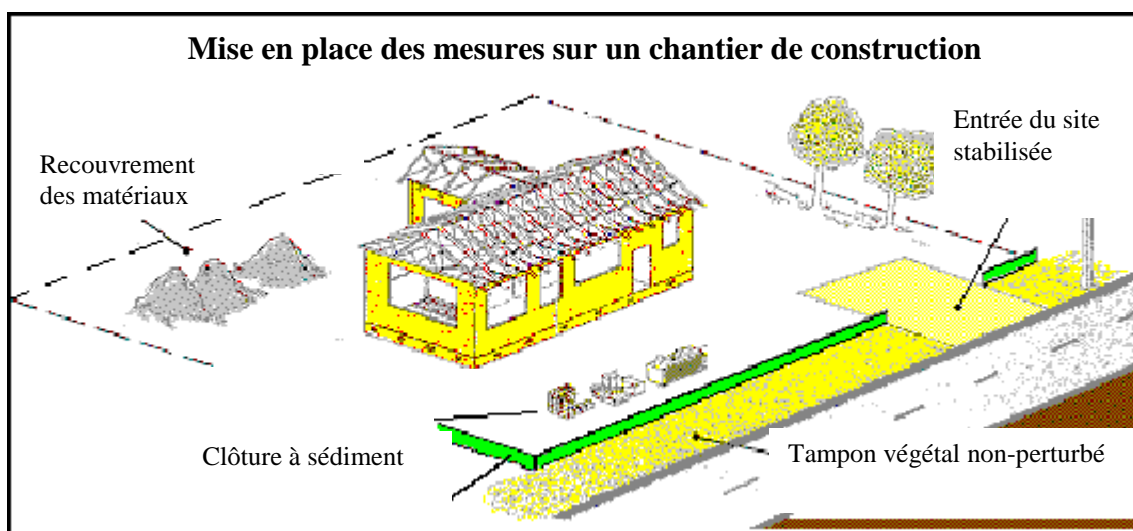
Mise en place des mesures sur un chantier de construction (d'après l'Australian Department of Environment, 1998).
